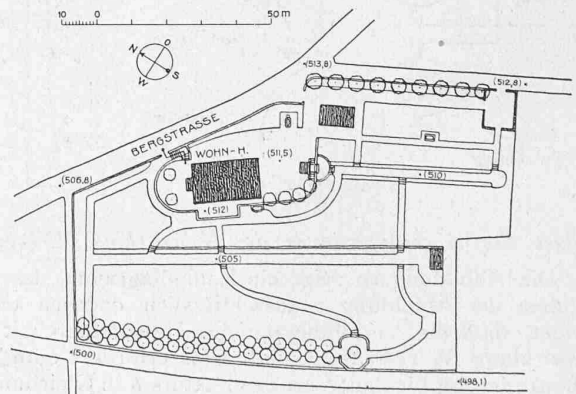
Lageplan des umgebauten „Schlössli“ in Zollikon. — 1:2000.
